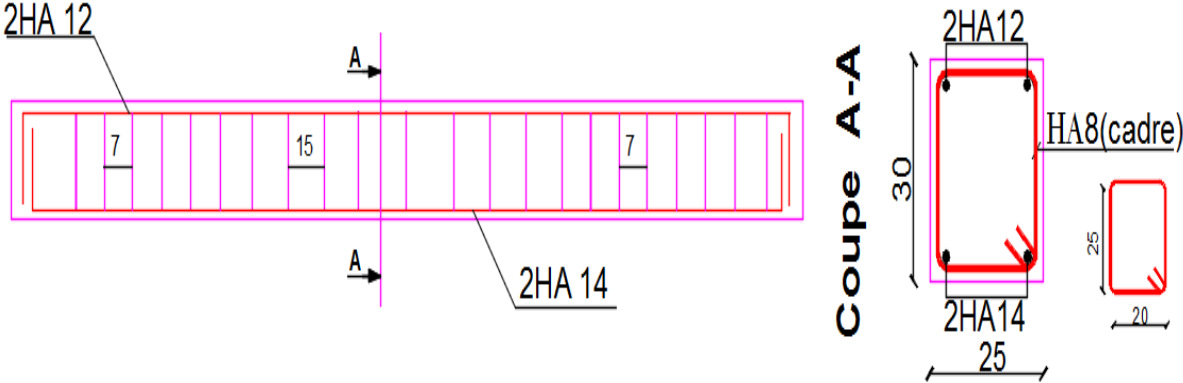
Schéma de ferrailage de la poutre de chinage.
